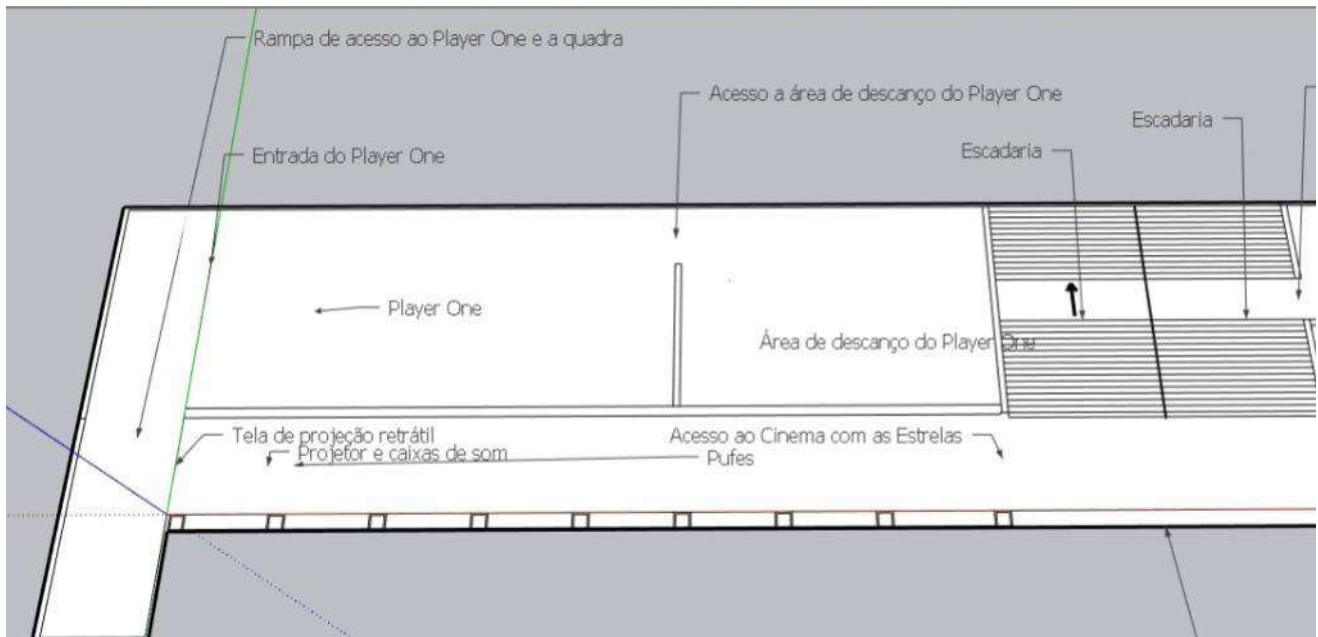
Planta baixa da área do Cinema com as Estrelas e a área Player One
